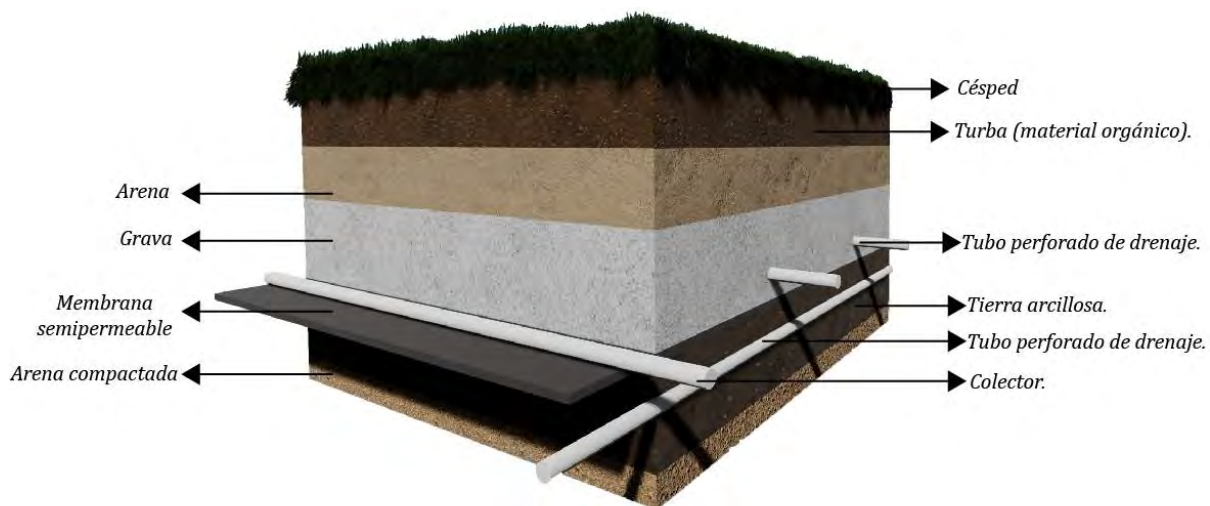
Detalle constructivo de cómo evacuar el agua de los árboles que se planea sembrar en las plazas. Fuente: Autora.
